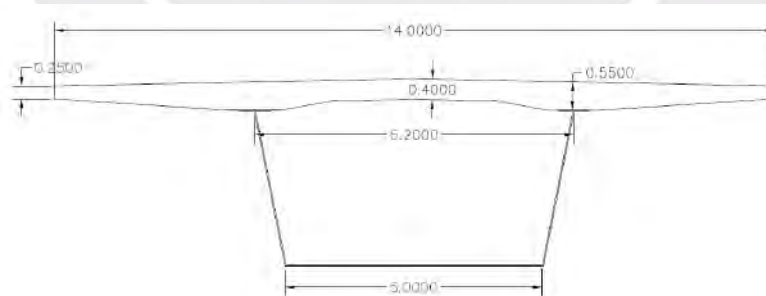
Sección Transversal del Tablero Tipo. Alternativa Puente Cajón Mixto
